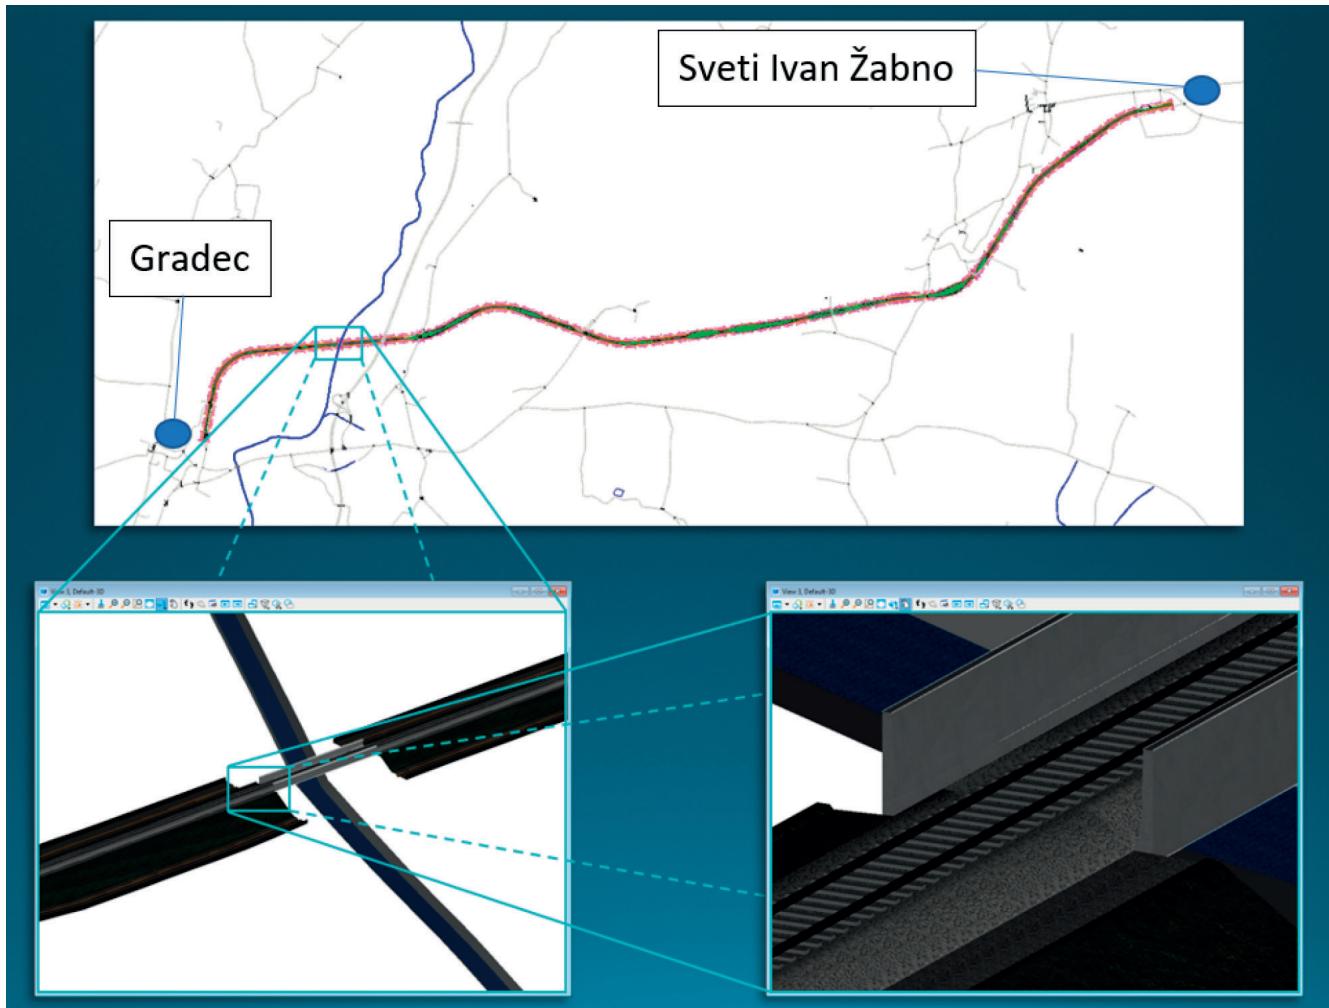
Cavalcavia sull'autostrada D10 con dettaglio di rotaie, traversine, massicciata, barriere.
